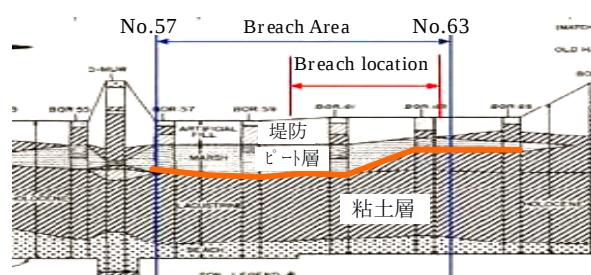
17th St. Canal の西側堤防土質縦断面図²⁾
